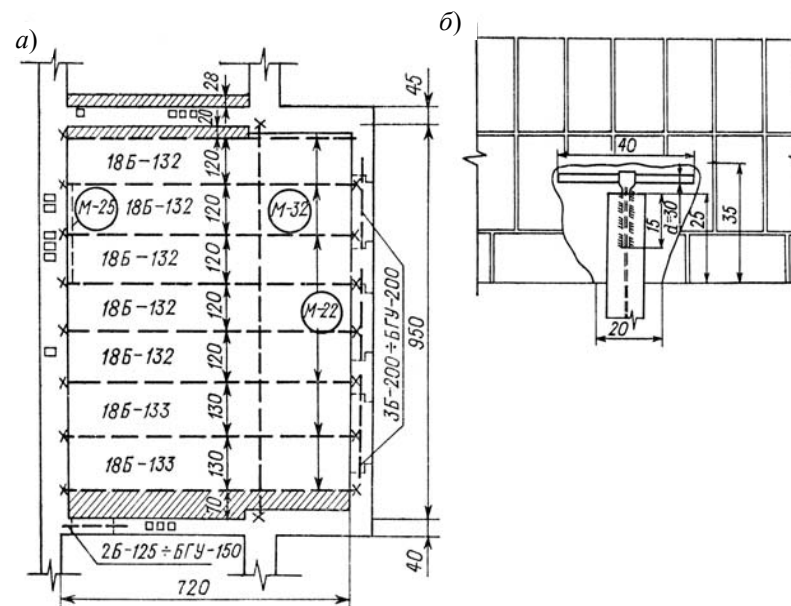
Перекрытие из стальных балок с заполнением плоскими железобетонными плитами: а – план участка перекрытия; б – анкеровка конца балки с пробивкой в стене гнезда в виде «ласточкина хвоста»
